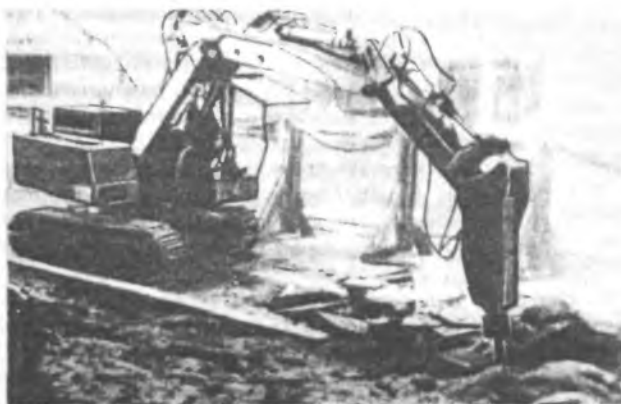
Использование дробящего молота НМ-600, смонтированного на экскаваторе UB-631 для разрушения бетонного покрытия
